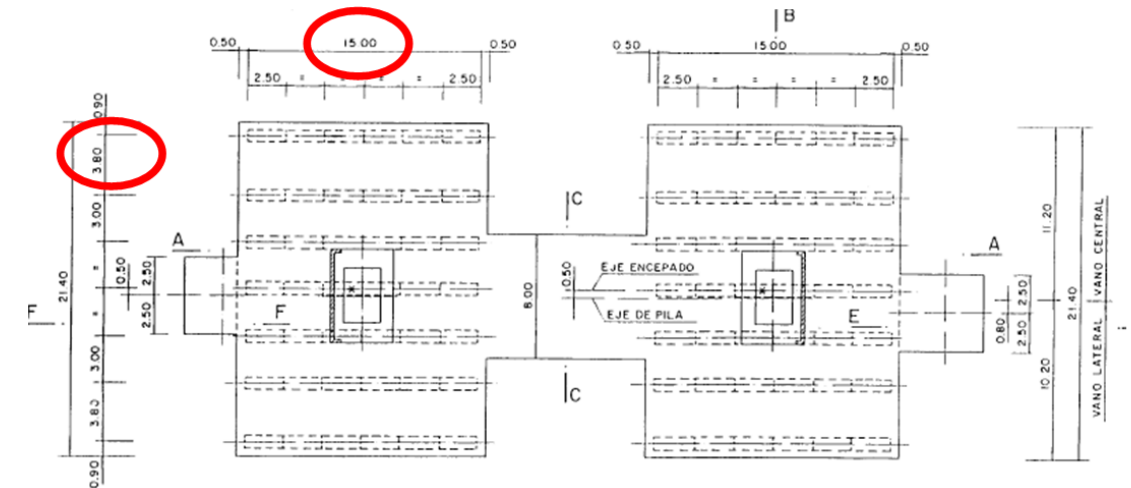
Planta de la cimentación del pilono P-15 (copiada del Proyecto Modificado n° 1)
